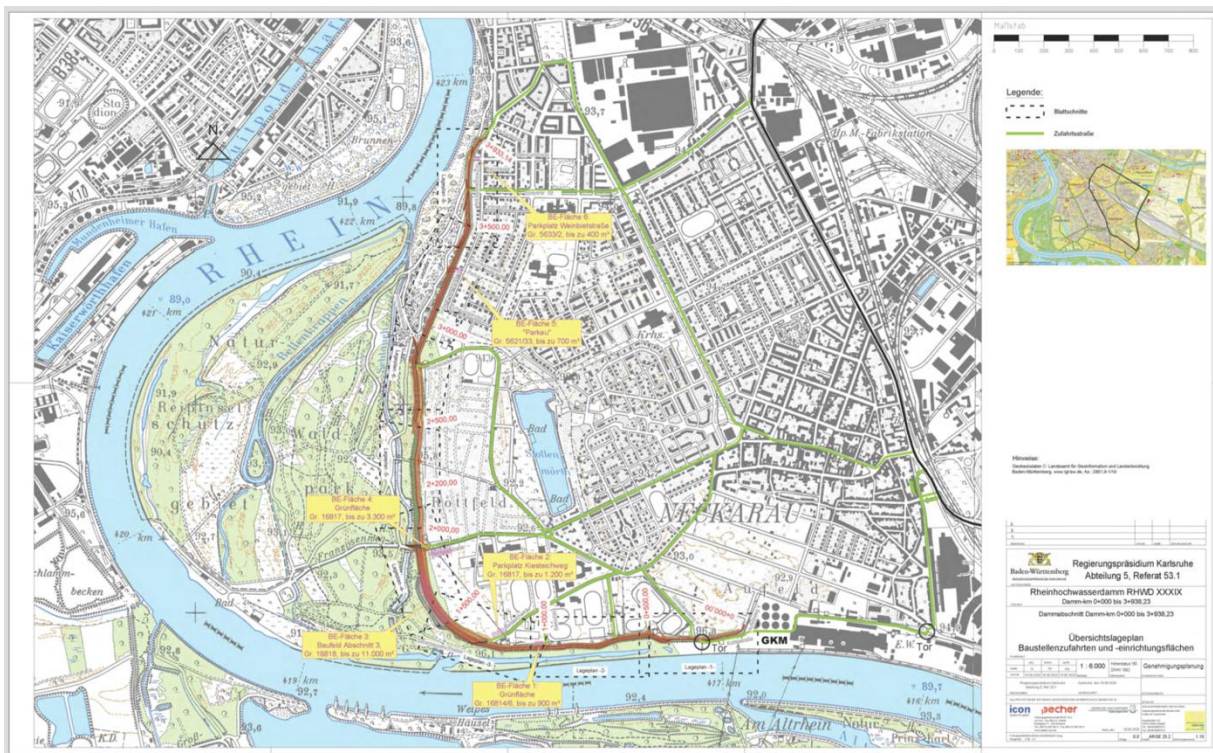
Übersichtslageplan Baustellenzufahrten und BE-Flächen, Plan Nr. 1.10
